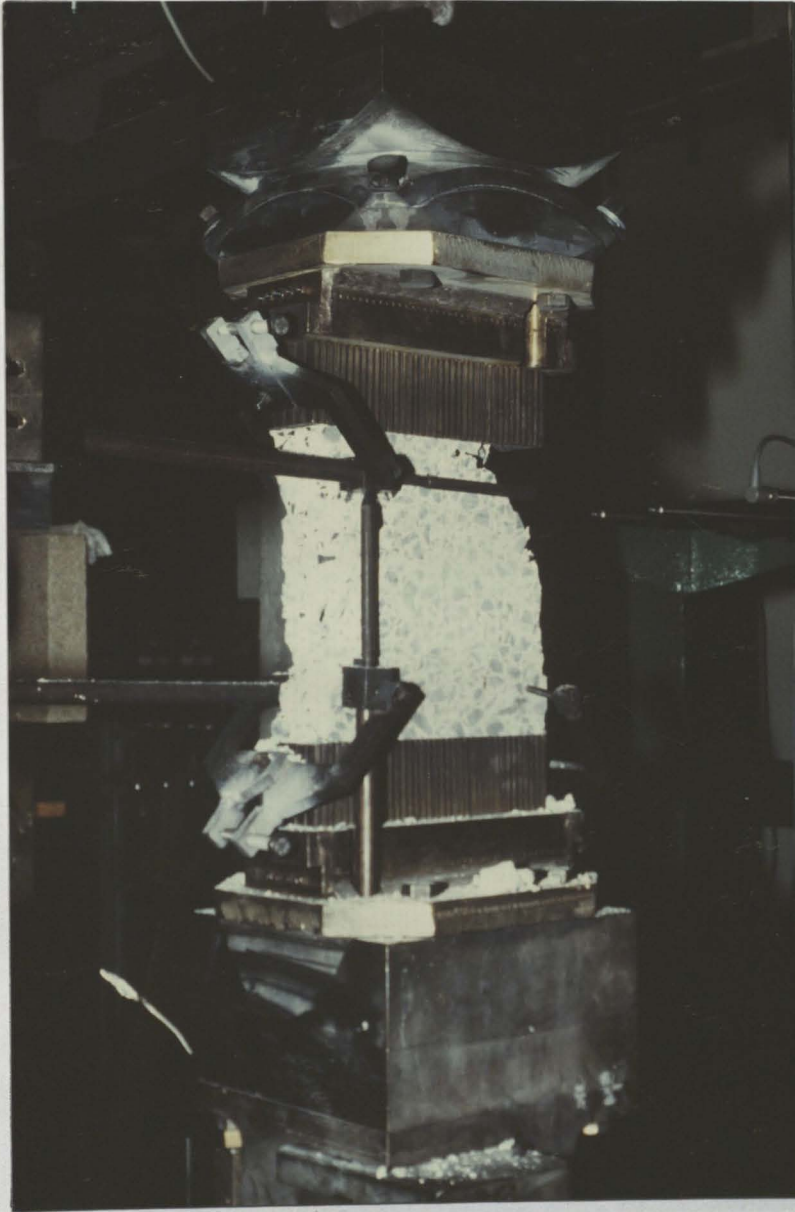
Eingebauter Stahlfaserbetonprobekörper mit installiertem Verformungsmeßsystem nach Durchführung eines einaxialen Druckversuchs.
